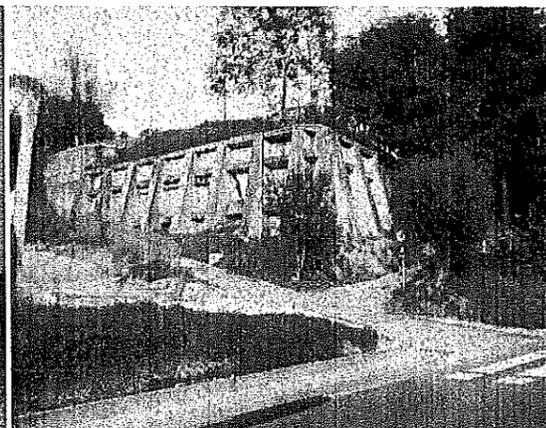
Muro di contenimento lato valle, a sostegno del terrapieno di livellamento. L'altezza del muro (e quindi del riporto) si aggira intorno agli 8.0 m rispetto la sede stradale di via Circonvallazione
